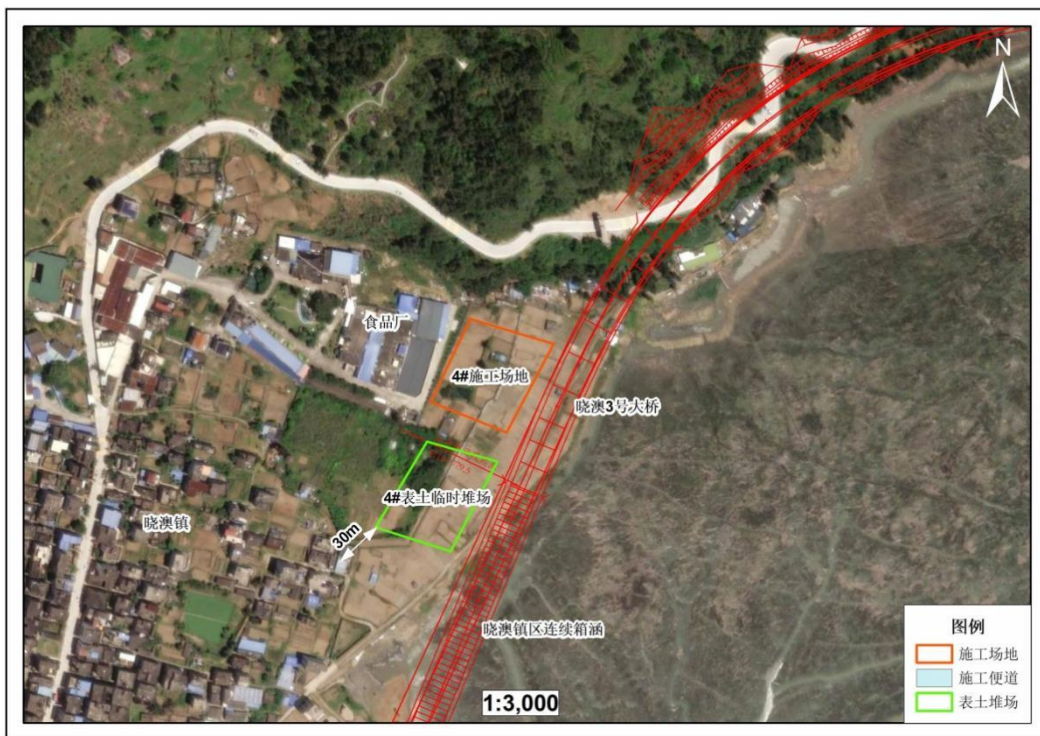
临时工程平面布置示意图（4#表土堆场、4#施工场地）
